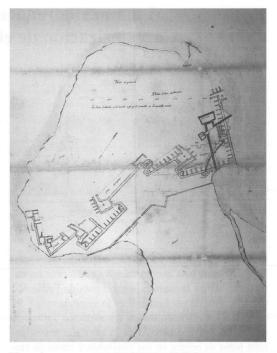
Planta de Peñíscola dibujado posiblemente por Bautista Antonelli. 1579. MPD.09.057 (Archivo General de Simancas.
